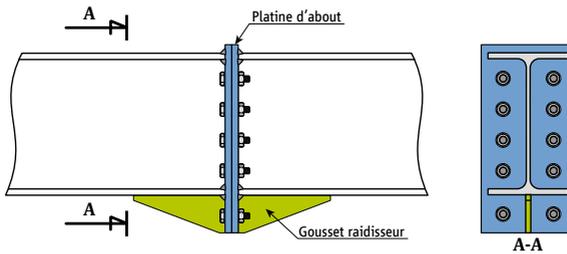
Assemblage de continuité par platine d'about débordante raidie
